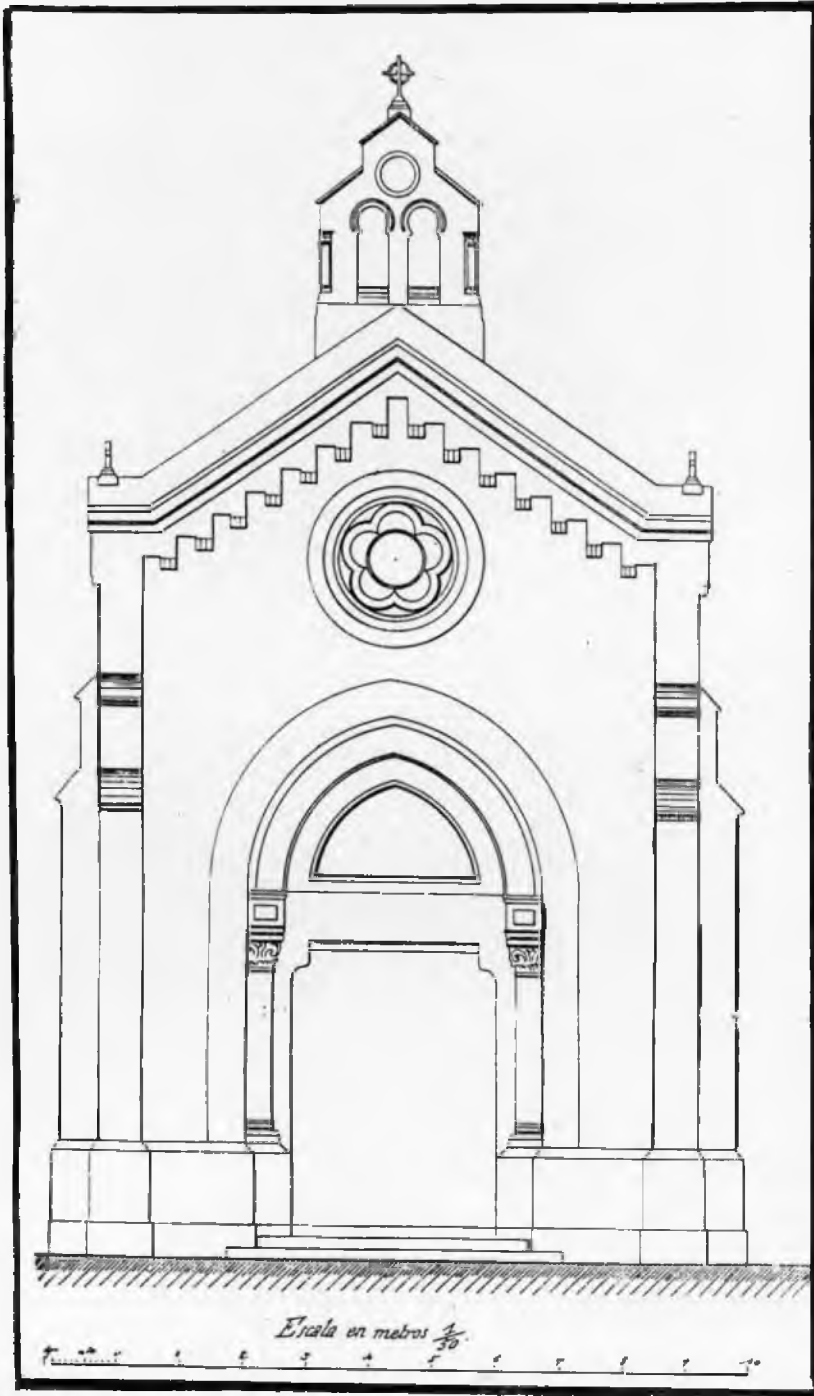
Alzado de la fachada principal de la capilla del cementerio nuevo.
